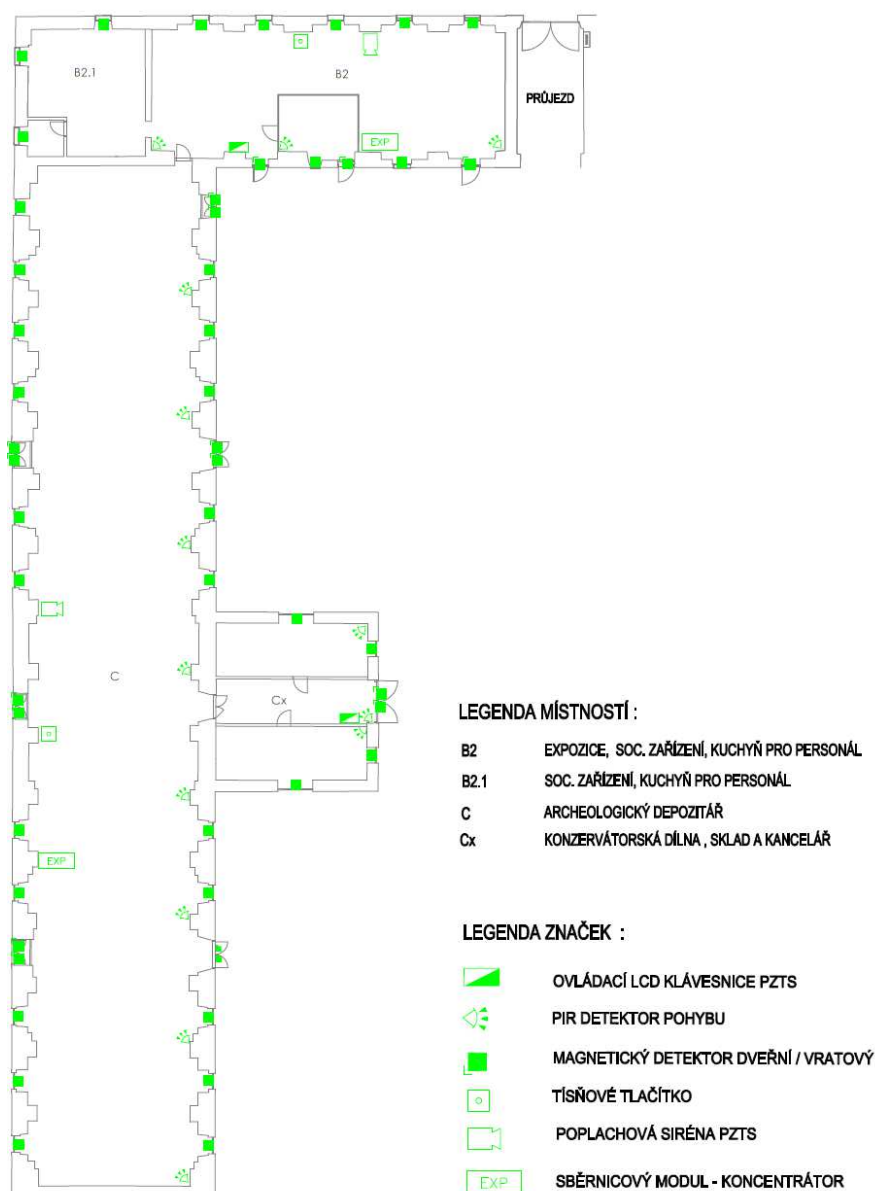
Půdorys umístění a instalace jednotlivých prvků PZTS
